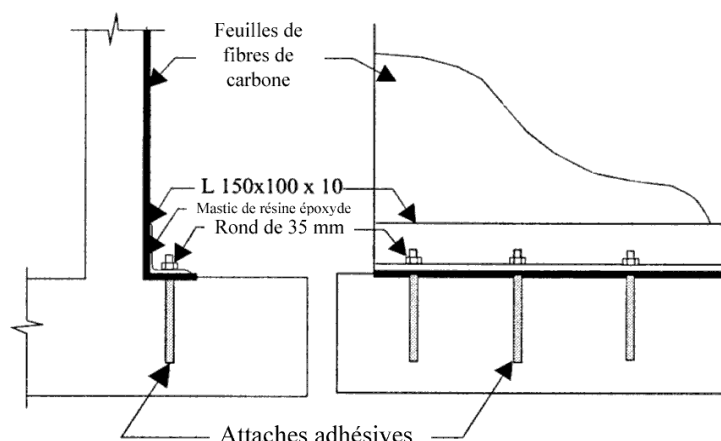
Plan du renforcement du composite (Pantelidis et coll. 2000).
